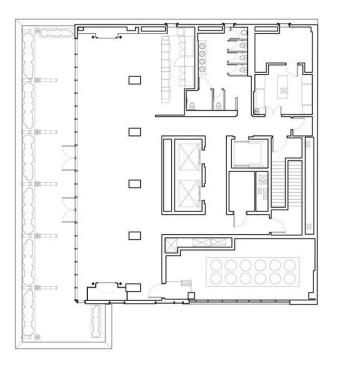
Planta baixa cobertura Ace Hotel Toronto
